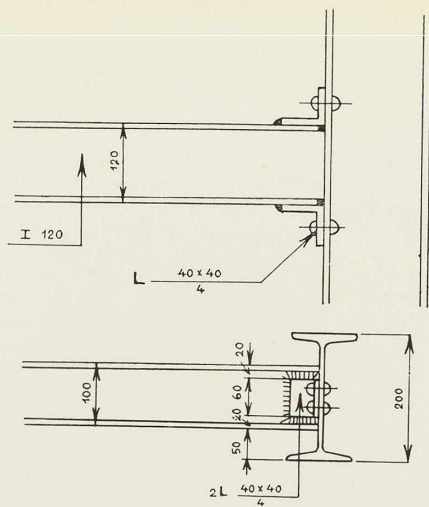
Assemblage d'une poutrelle d'entretoisement et d'un poteau.
